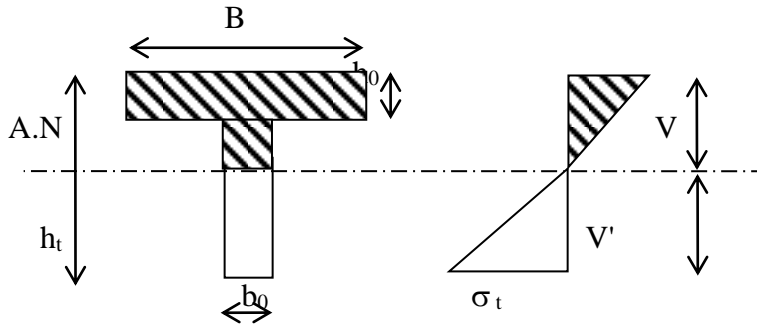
Notations utilisées pour le calcul de section d'acier pour une poutre en T
